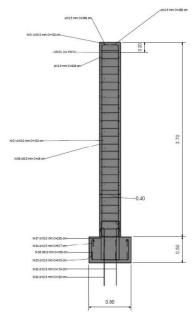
detalhamento das armaduras da contenção de concreto a ser executada para conter a erosão do talude nas cabeceiras da ponte; Fonte: o autor.
